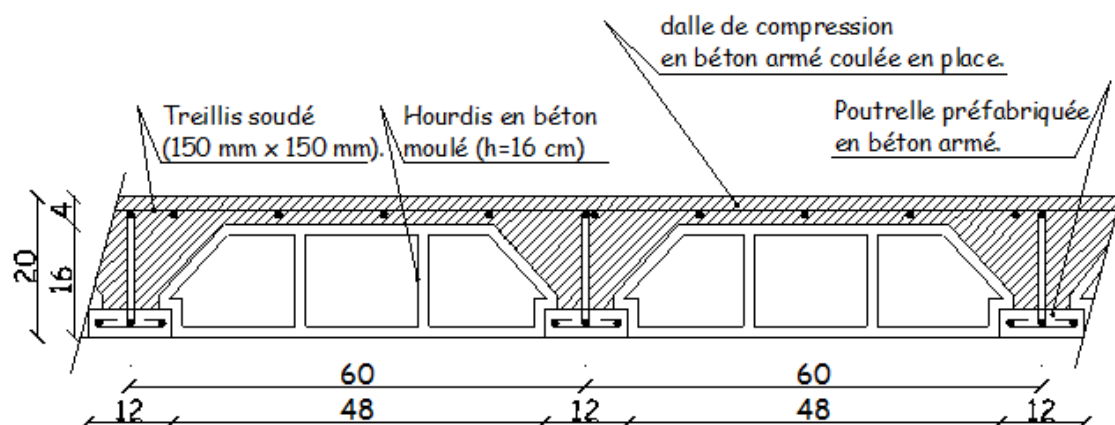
Schéma des plancher en béton armé avec poutrelles et hourdis
